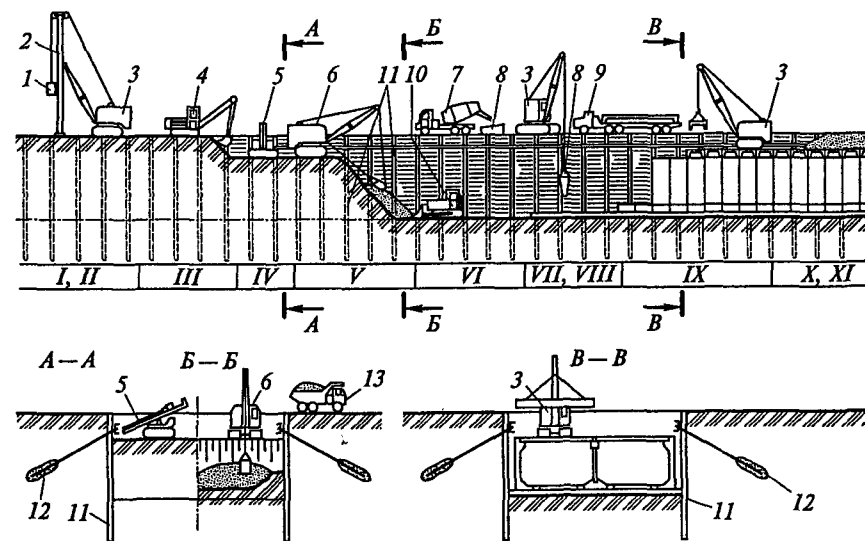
Технологическая схема сооружения тоннеля котлованным способом:
